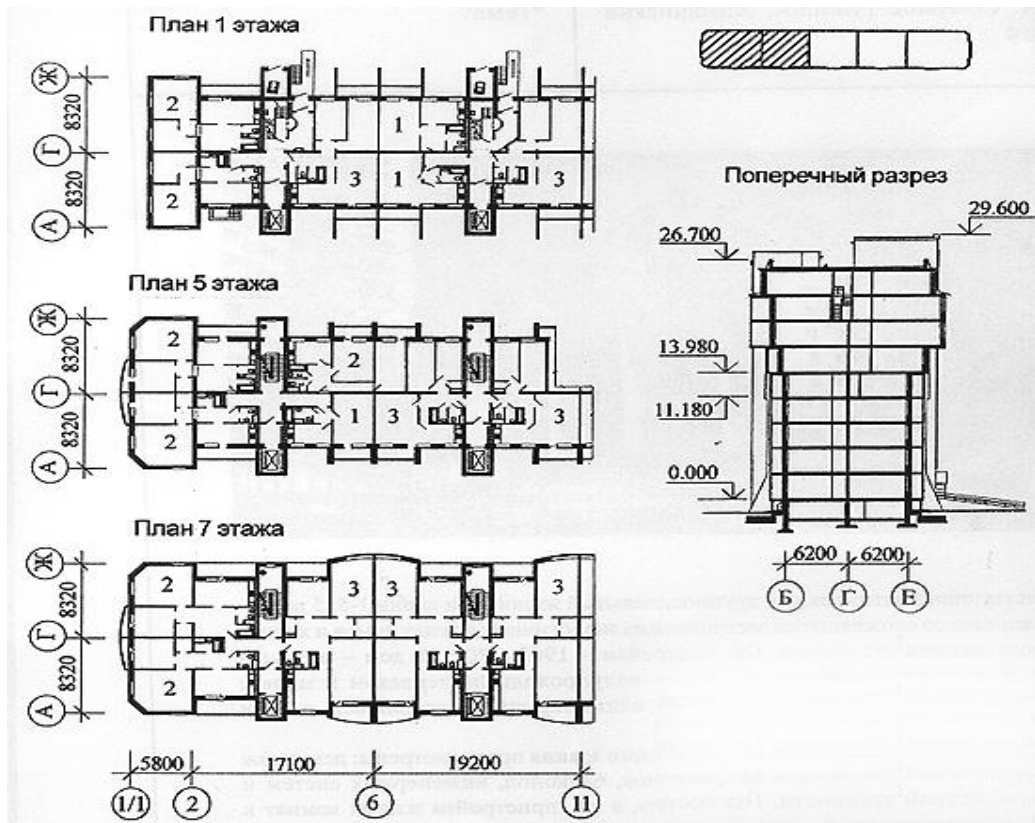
Реконструкция жилого 5-ти этажного дома серии 1-515 в г.Москве (с надстройкой четырех этажей). Планы, разрезы
